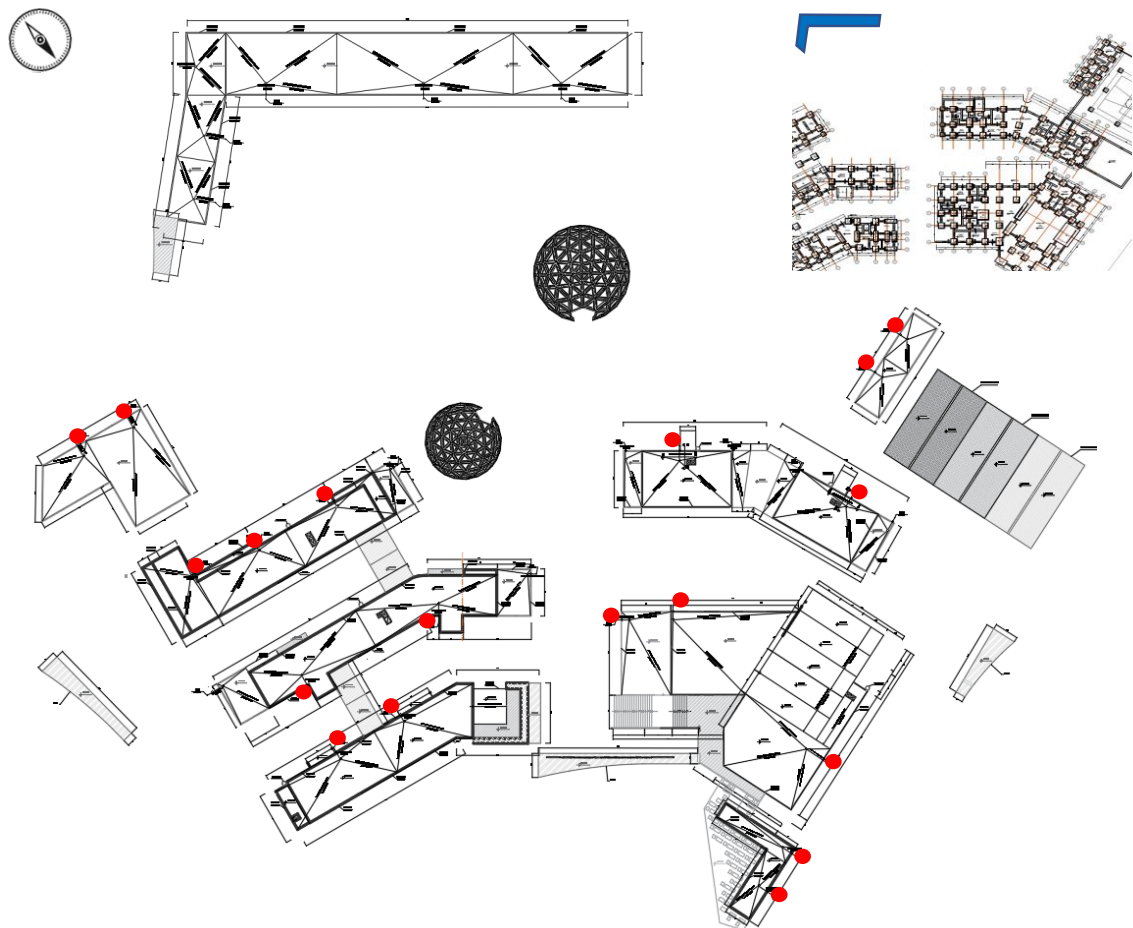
Plano de sistema pluvial del planteamiento general (ubicación de tuberías de PVC)
